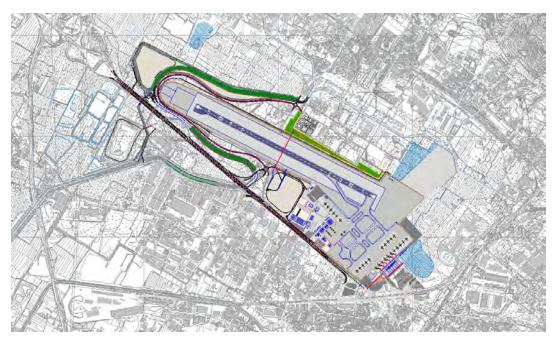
stralcio della planimetria di progetto dell'Aeroporto "Amerigo Vespucci"
